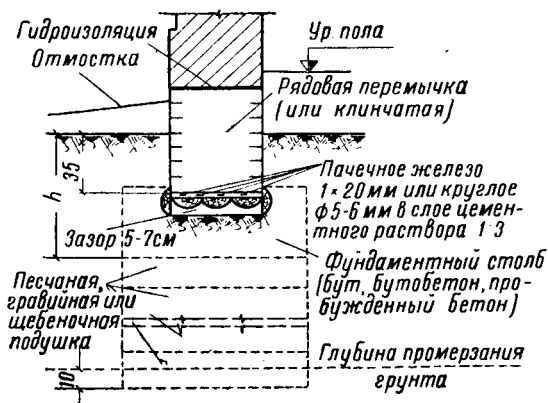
Фундаменты под каменные стены в пучинистых грунтах для зданий без динамических и крановых нагрузок
